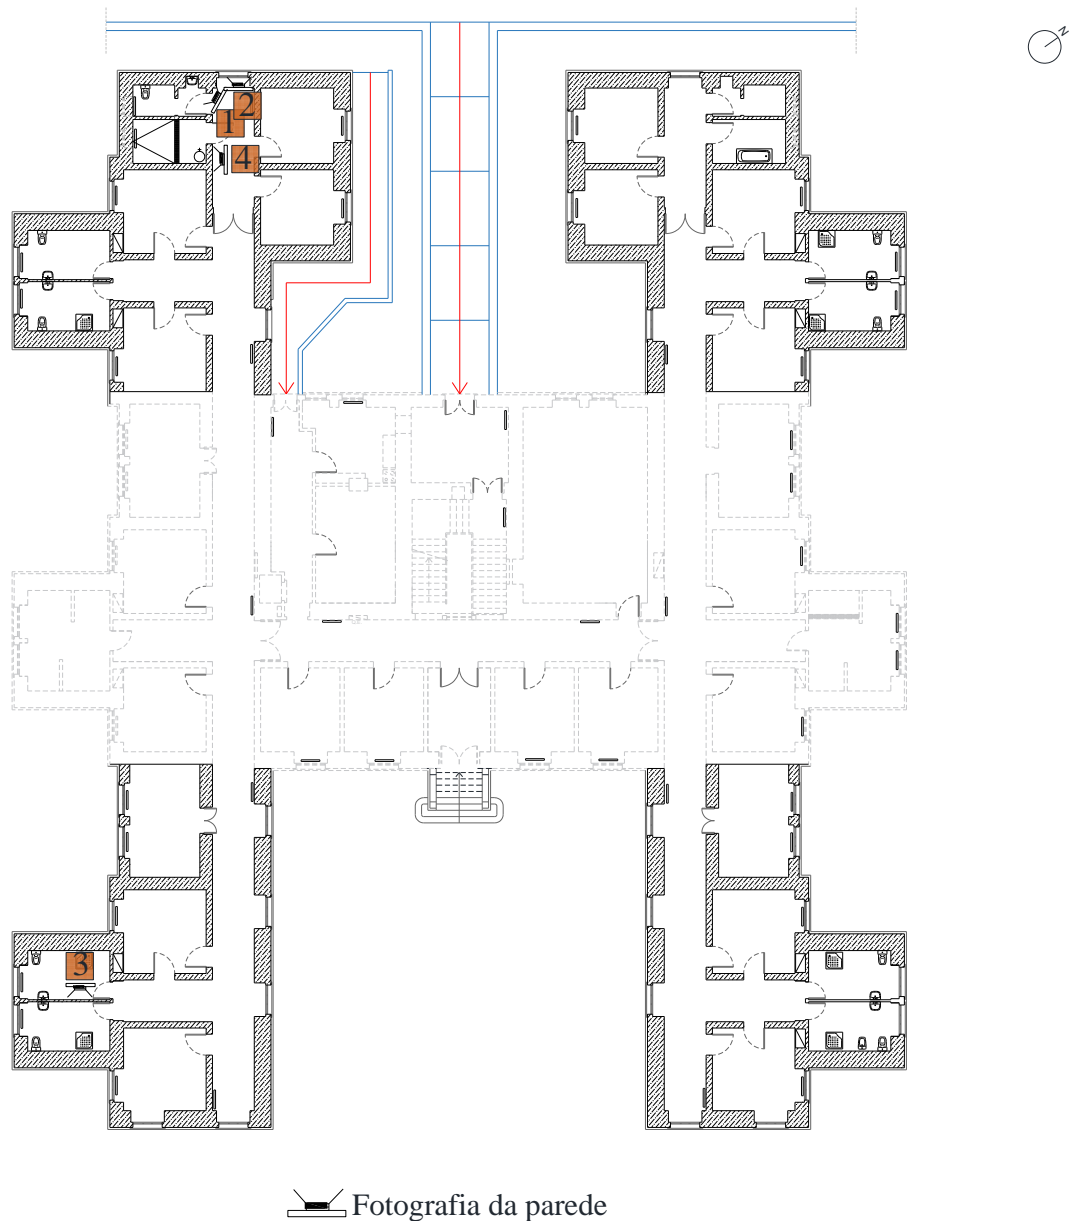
Localização das Imagens , na planta do Piso 0 [Fonte: Planta cedida pelo C.H.J.M]
